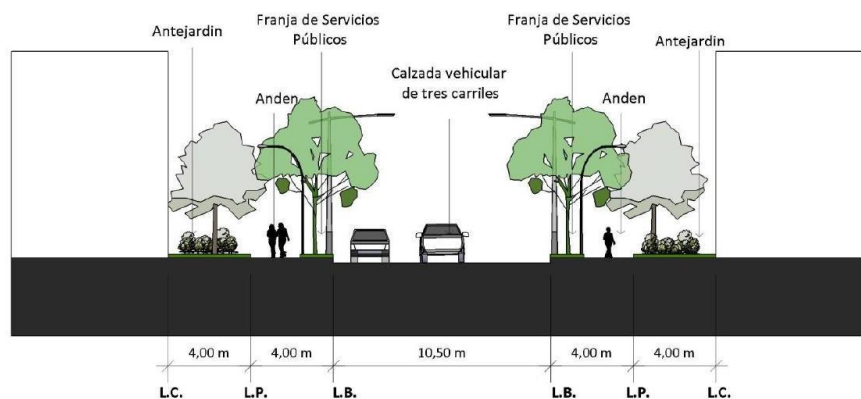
Sección típica perfil V-4. Fuente: POT Barranquilla.
